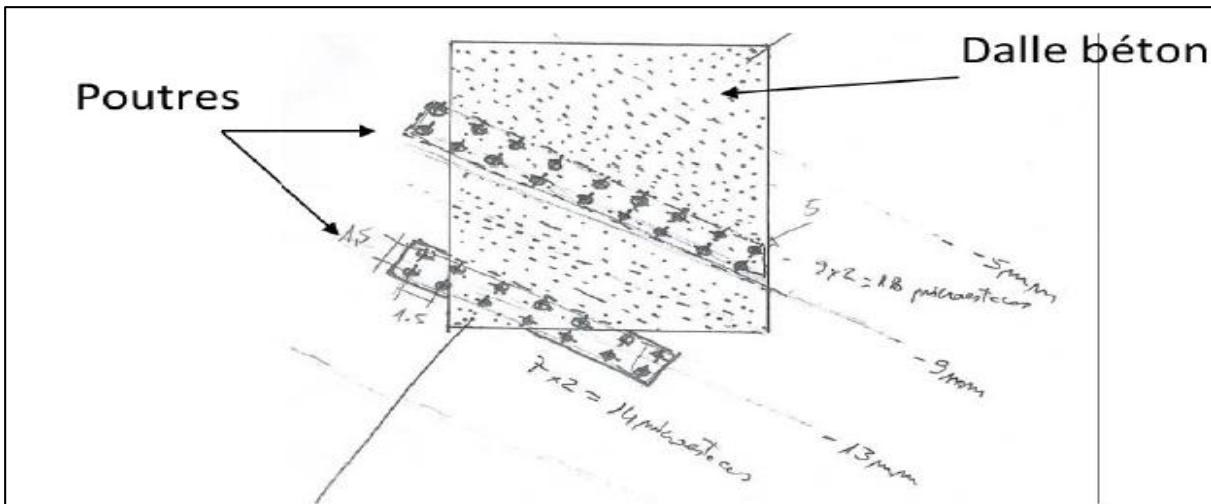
Plan schématique de la situation de renforcement sous le bâtiment
